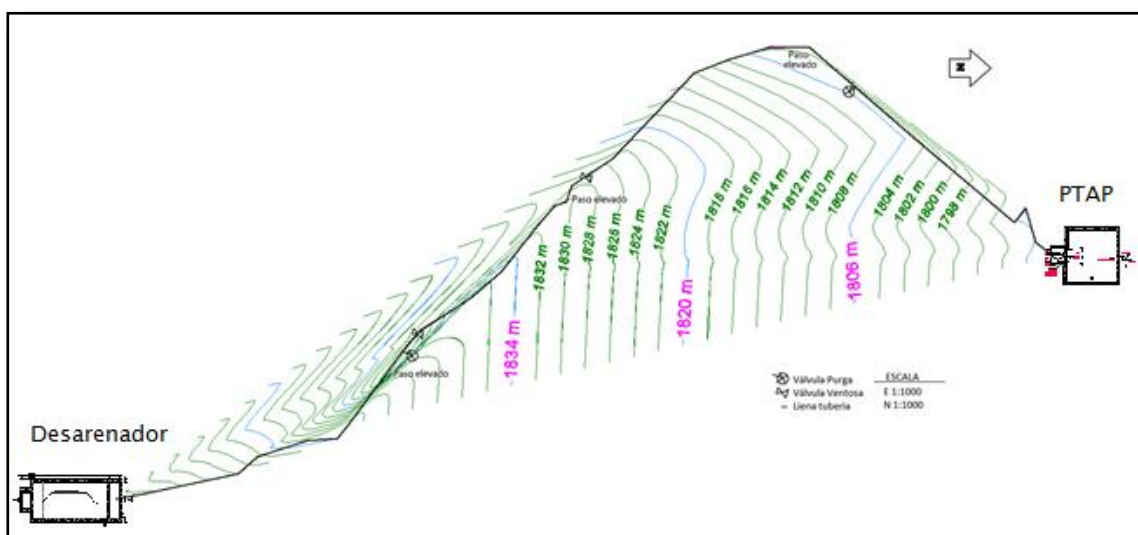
Plano en planta, línea de aducción Desarenador-PTAP. Fuente: Autores del proyecto.
